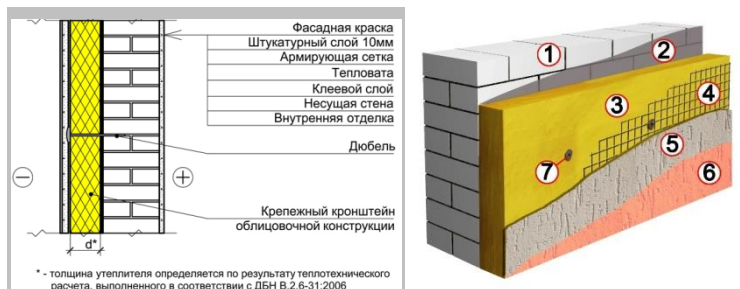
Схема утепления «штукатурный» фасад: 1 – несущая стена; 2 – клеевой слой; 3 – утеплитель; 4 – арматурная сетка; 5 – слой штукатурки; 6 – фасадная краска; 7 – дюбель.
